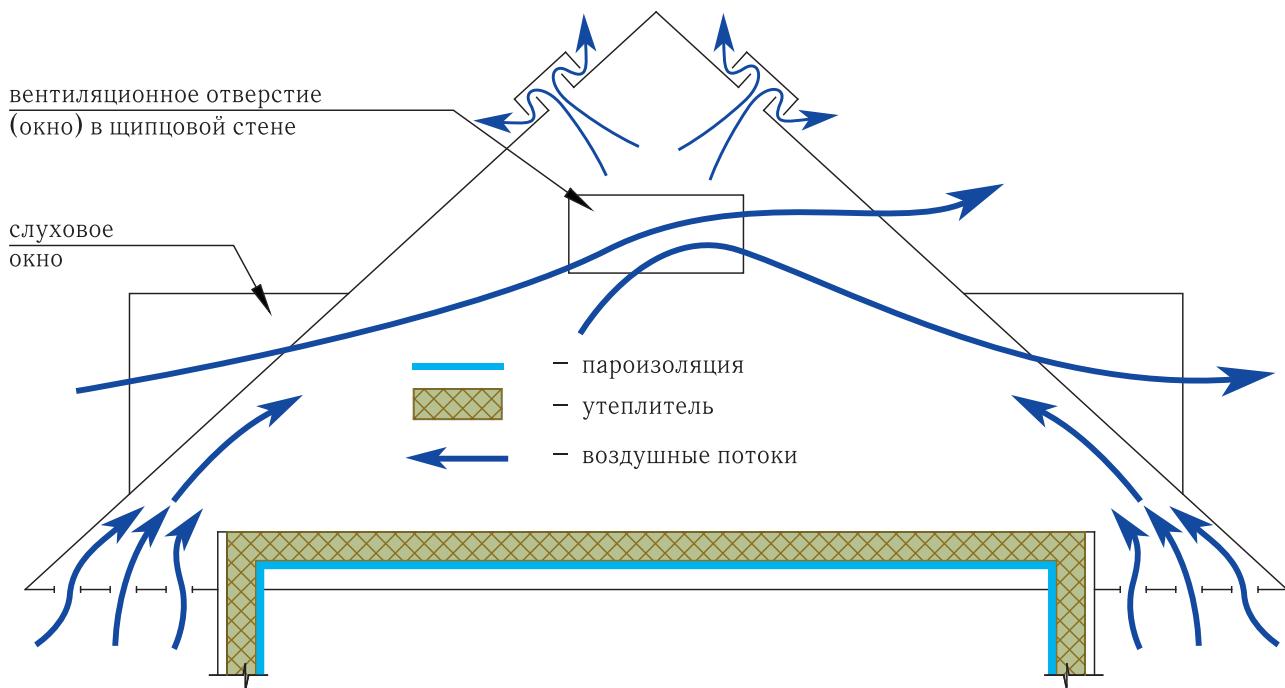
Схема утепления, пароизоляции и вентиляции нежилого чердачного помещения
